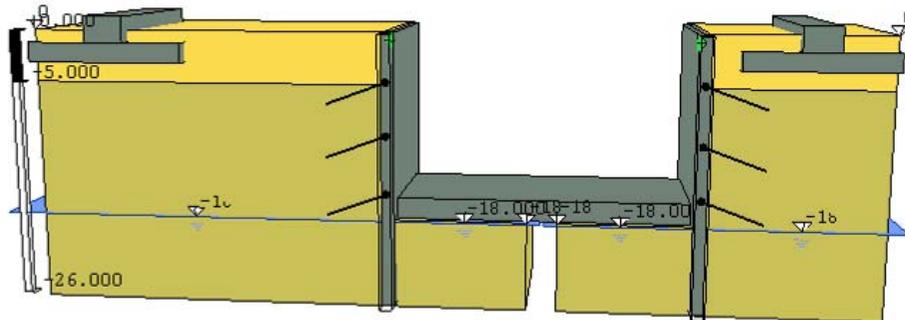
Fase 11 : Getto del Solettone di Fondo
